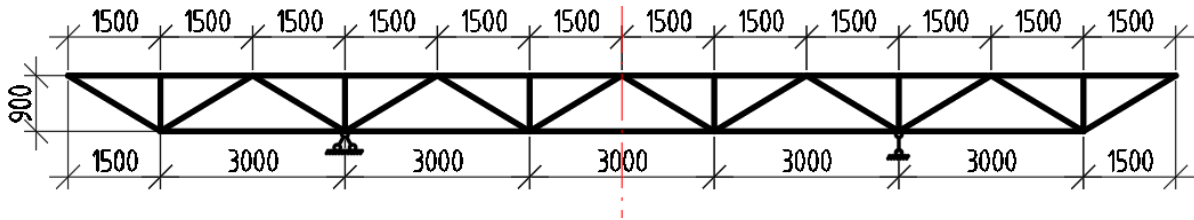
Консольно-балочная ферма (грузовой пояс – верхний, узловая нагрузка 3 кН, 1.5 кН)
